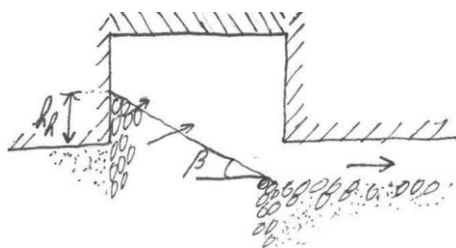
Uitspoeling van bovendeele barrière aansluitend op benedenstroomse pipe tot ongeveer een hellingshoek gelijk aan de hoek van inwendige wrijving. De geschetste situatie betreft een relatief brede barrière met een relatief lage inkassing (zijaanzicht met enige 3D-suggestie in langsrichting).
